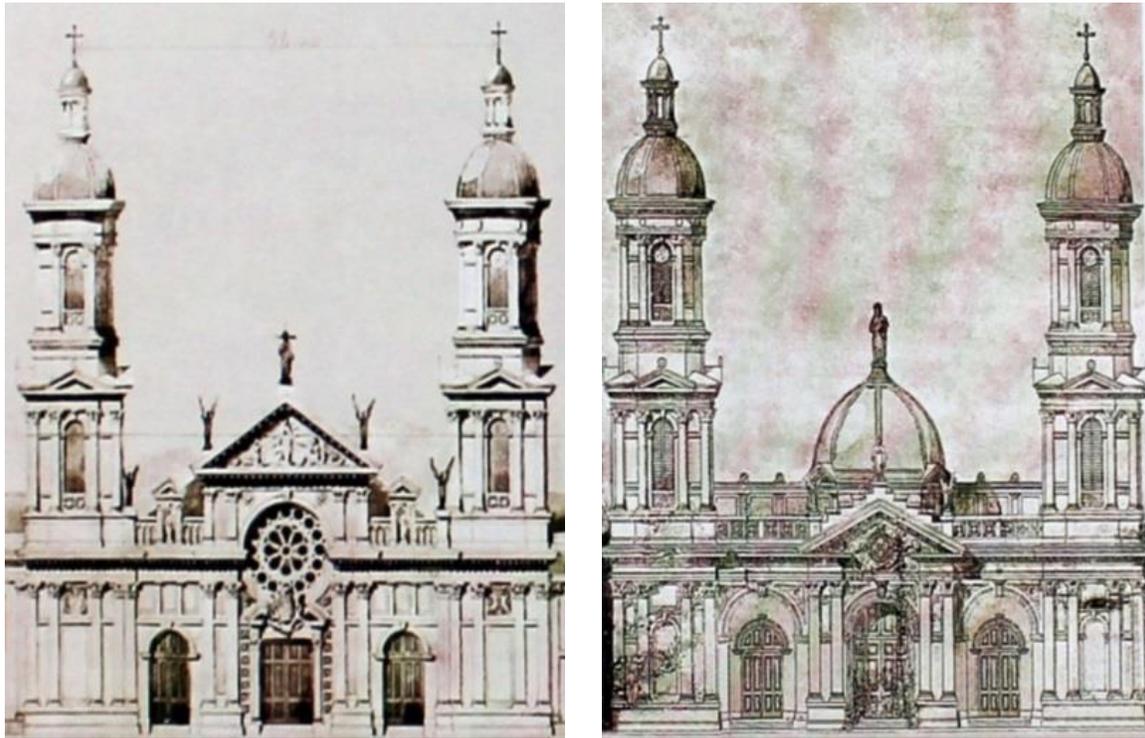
Alternativas de fachada y torres proyectadas por Joannon para Catedral de Concepción. Fuente: Archivo Joannon, 1904.
